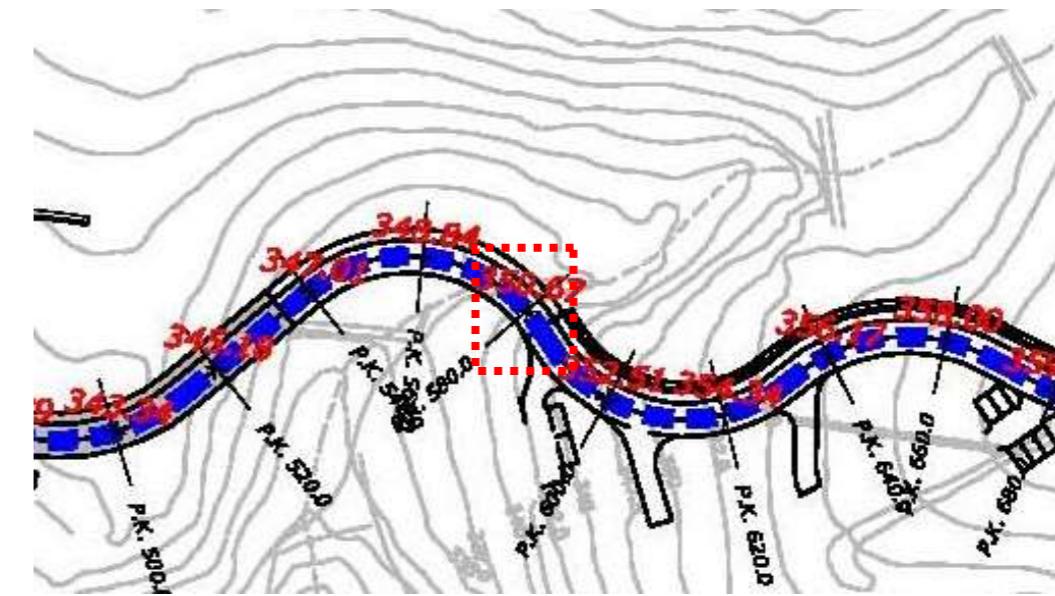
Detalle de planta red vial eje C (Plan Parcial Maguenes. Plano O-6)
